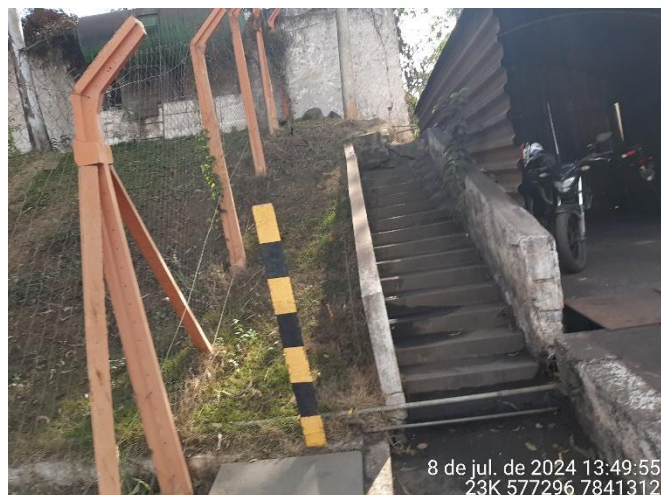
Estrutura semelhante à escada por onde verte o efluente proveniente do pátio do Posto Campeão.
